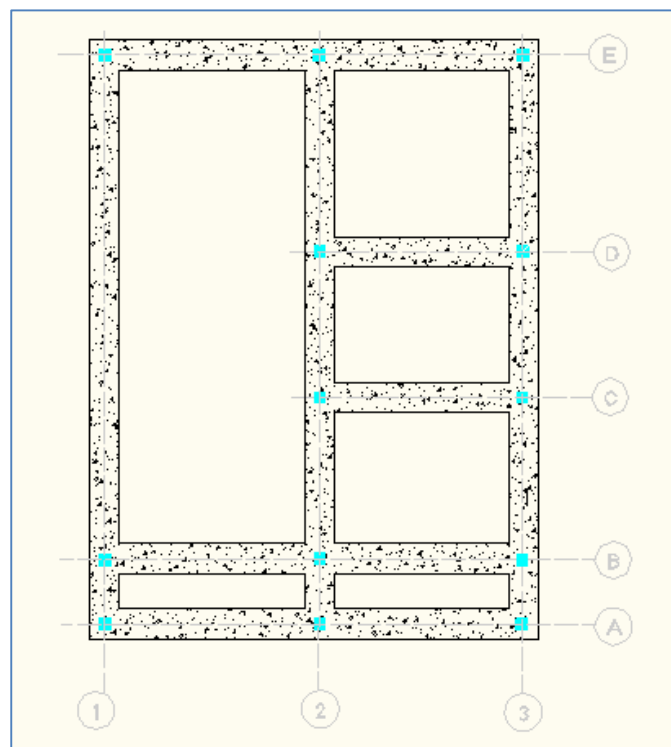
Planta de Cimentación pilares fundidos en concreto ciclópeo vivienda Prototipo
